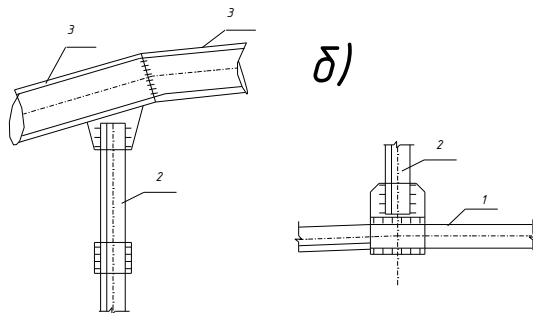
Вузол зєднання стійки: а) з верхнім поясом; б) з нижнім поясом арки
